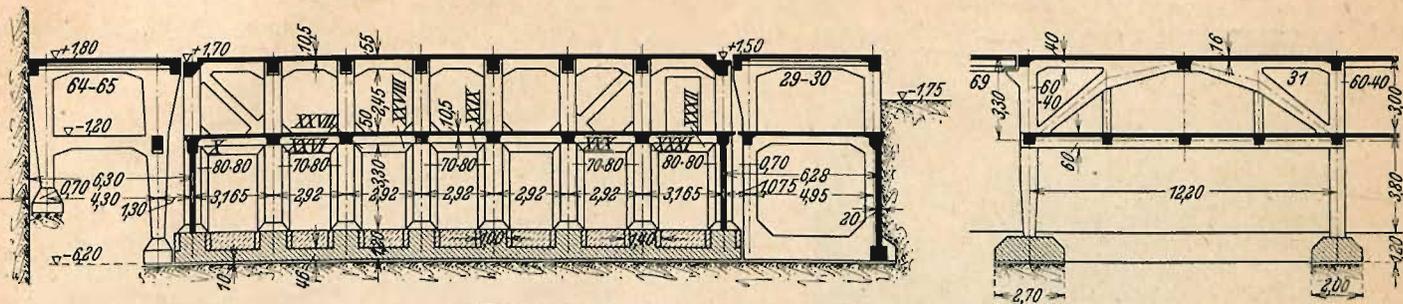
u. 5. Eisenbetonfundamente. Querschnitt.
